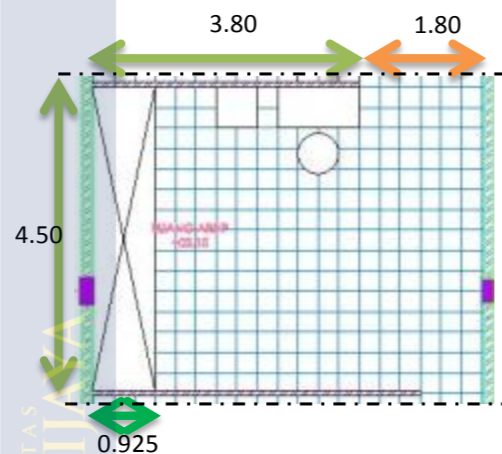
Ruang-ruang servis lantai 1 Asuransi ABDA
